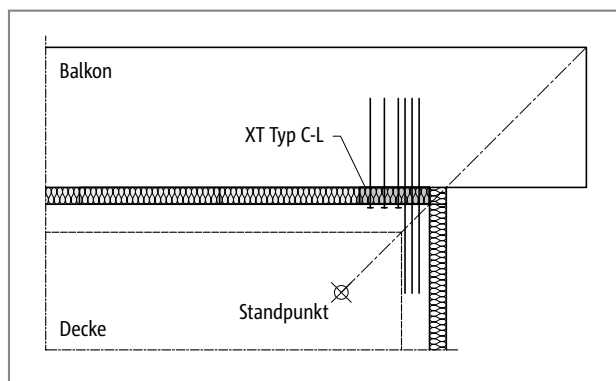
Schöck Isokorb® XT Typ C: Balkon über Gebäudeecke auskragend (Einsatz XT Typ C-L)
